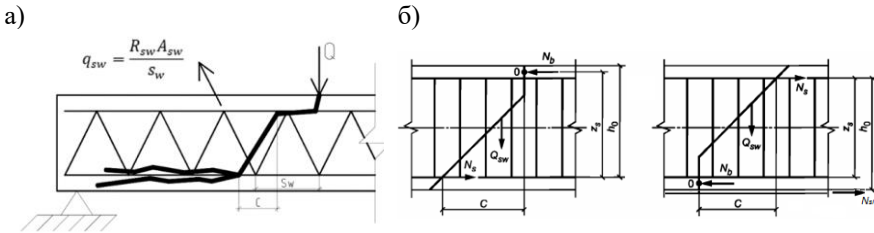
а) Схема расчетных усилий в расчете по прочности наклонных сечений; б) Схема усилий при расчете железобетонных элементов по наклонному сечению на действие изгибающих моментов
